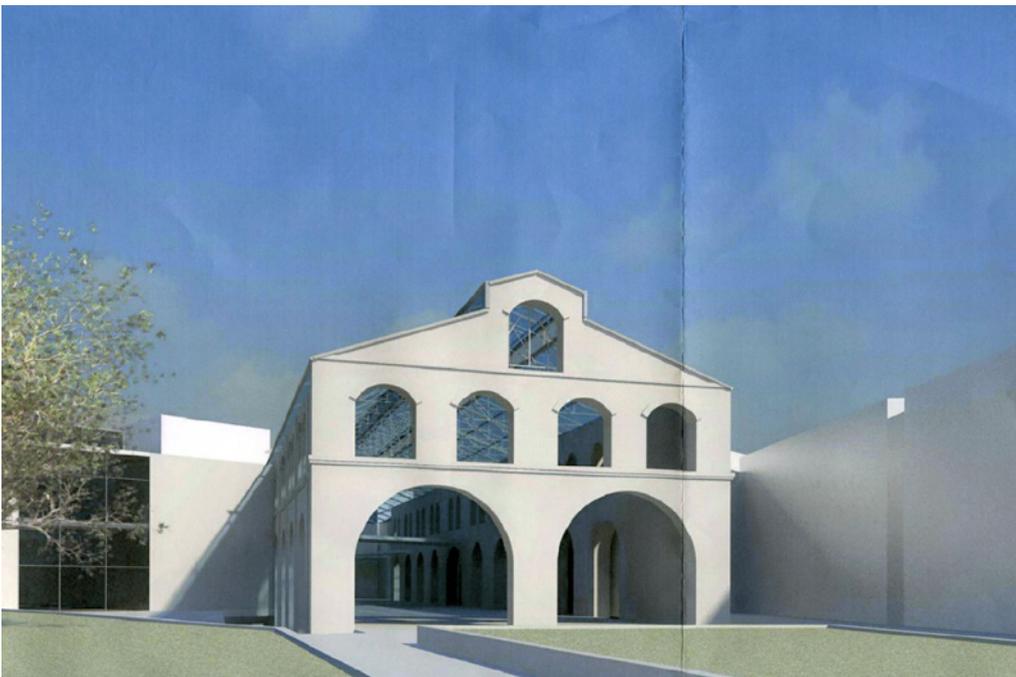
Peter Eisenman. Progetto nell'area della ex Sofer. Ingresso dal capannone esistente.
